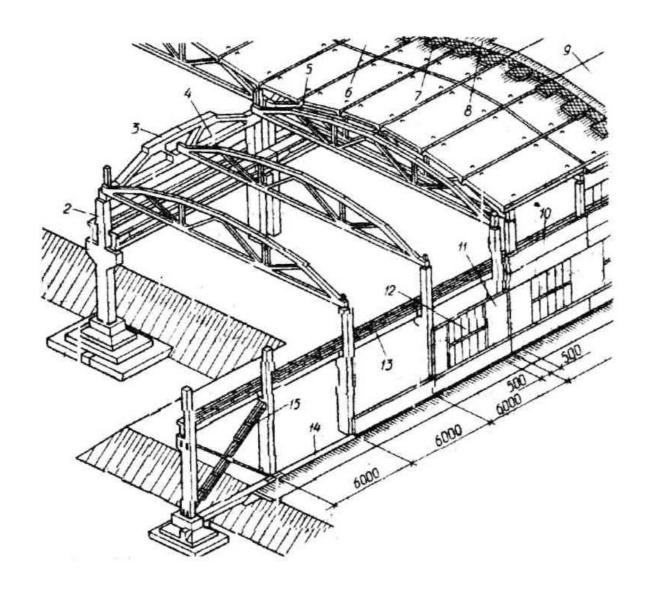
Конструкции производственного здания: 1 — сборный фундамент; 2 — колонна среднего ряда; 3 — подстропильная ферма; 4 — стропильная ферма; 5 — температурный шов; 6 — сборная железобетонная плита покрытия; 7 — утеплитель по пароизоляции; 8 — цементно-песчаная стяжка; 9 — кровельный ковер (рубероид на мастике); 10 — рядовая стеновая панель; 11 — простеночная панель; 12 — окно; 13 — железобетонная подкрановая балка; 14 — фундаментная балка; 15 — крестовые металлические связи
